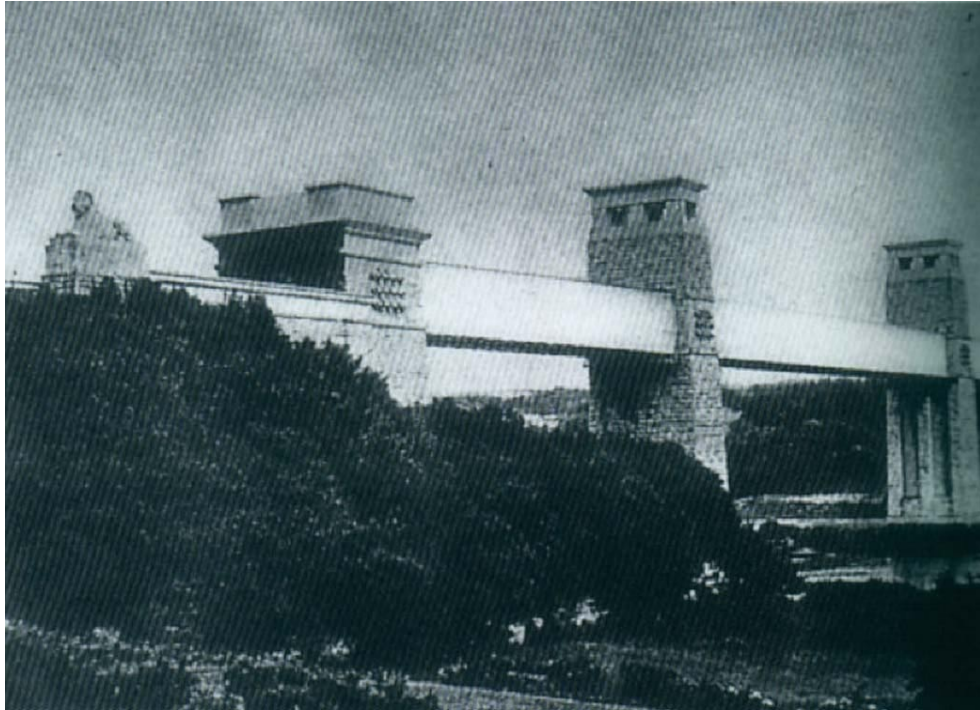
Britannia Railway Bridge – Londres, Inglaterra
